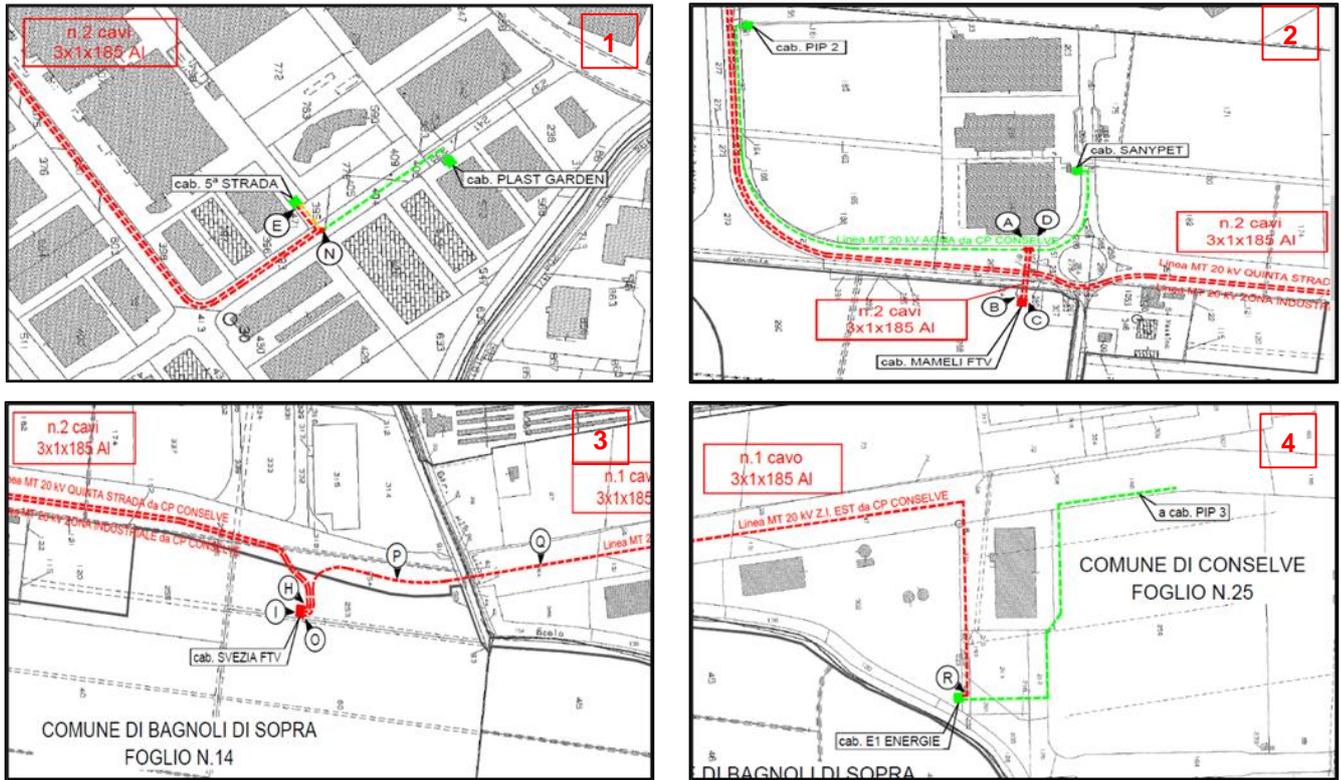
Punti di dettaglio della posizione linea elettrica di collegamento e individuazione tratti
